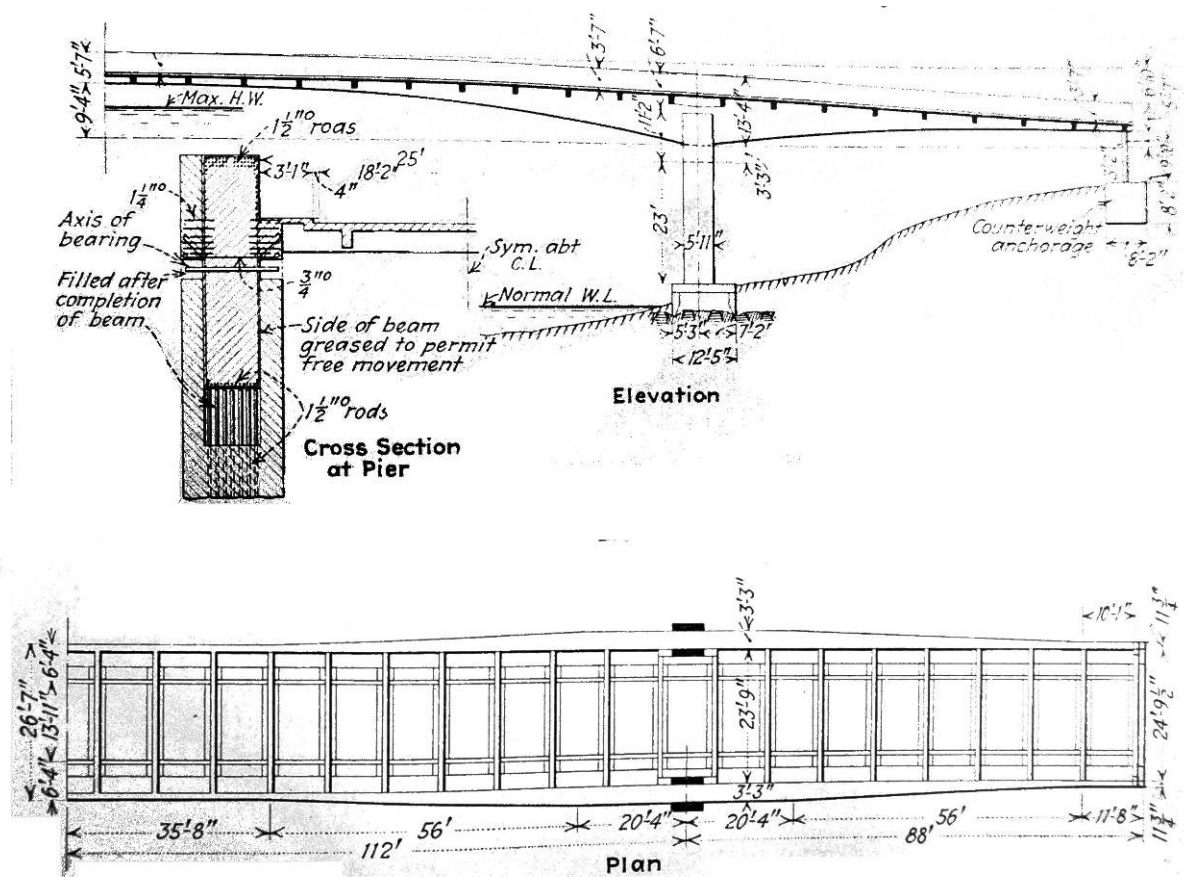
Planta, elevação e corte do pilar. FONTE: SCHJÖDT, 1930.
